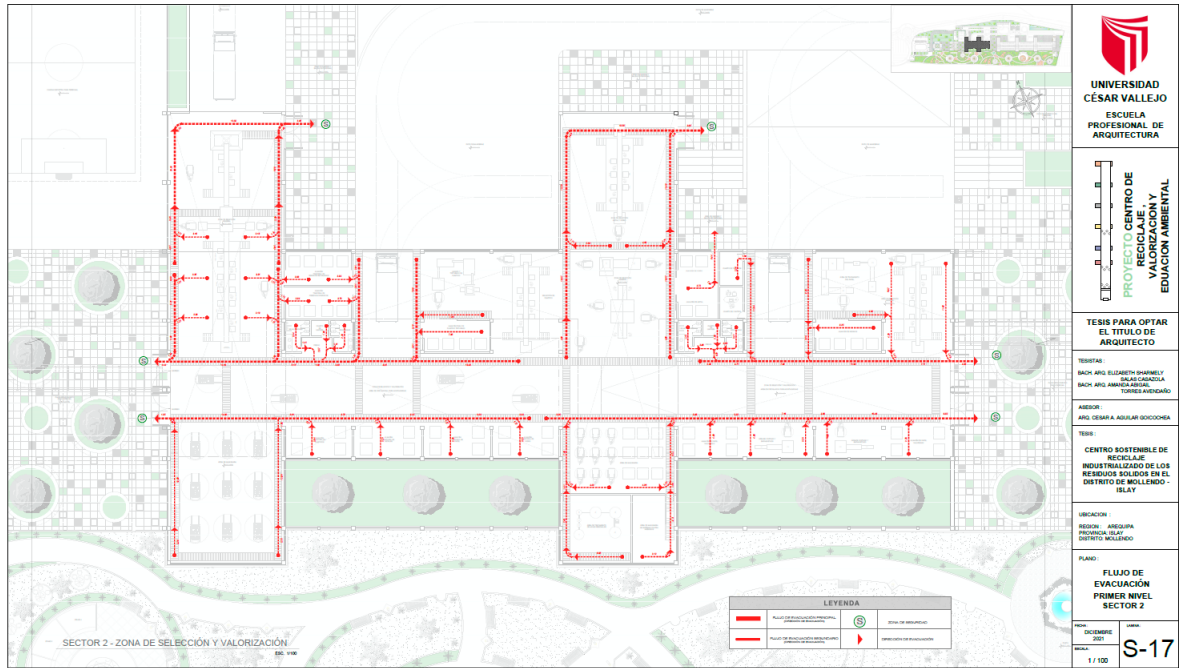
Plano de Evacuación, Sector 2 – Primer Nivel
